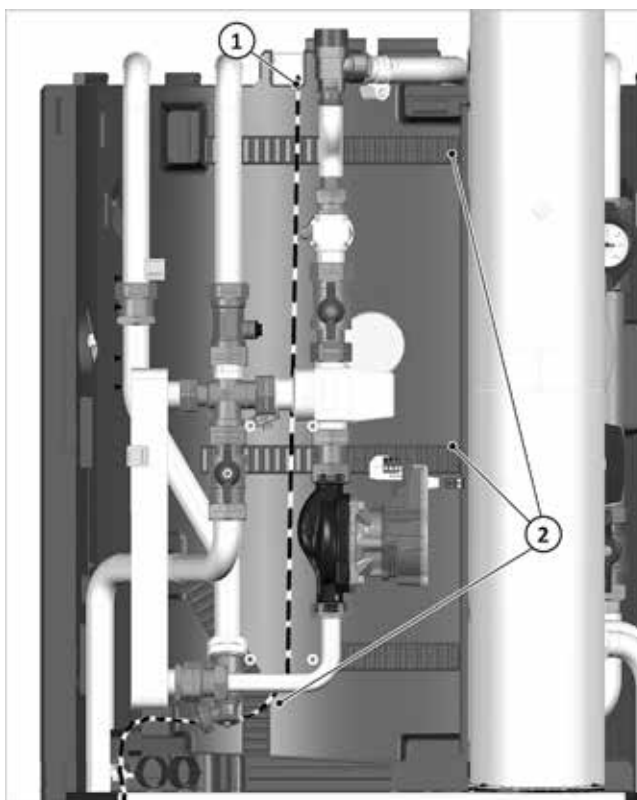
guidage de la conduite à travers l'isolation de la station d'eau chaude
